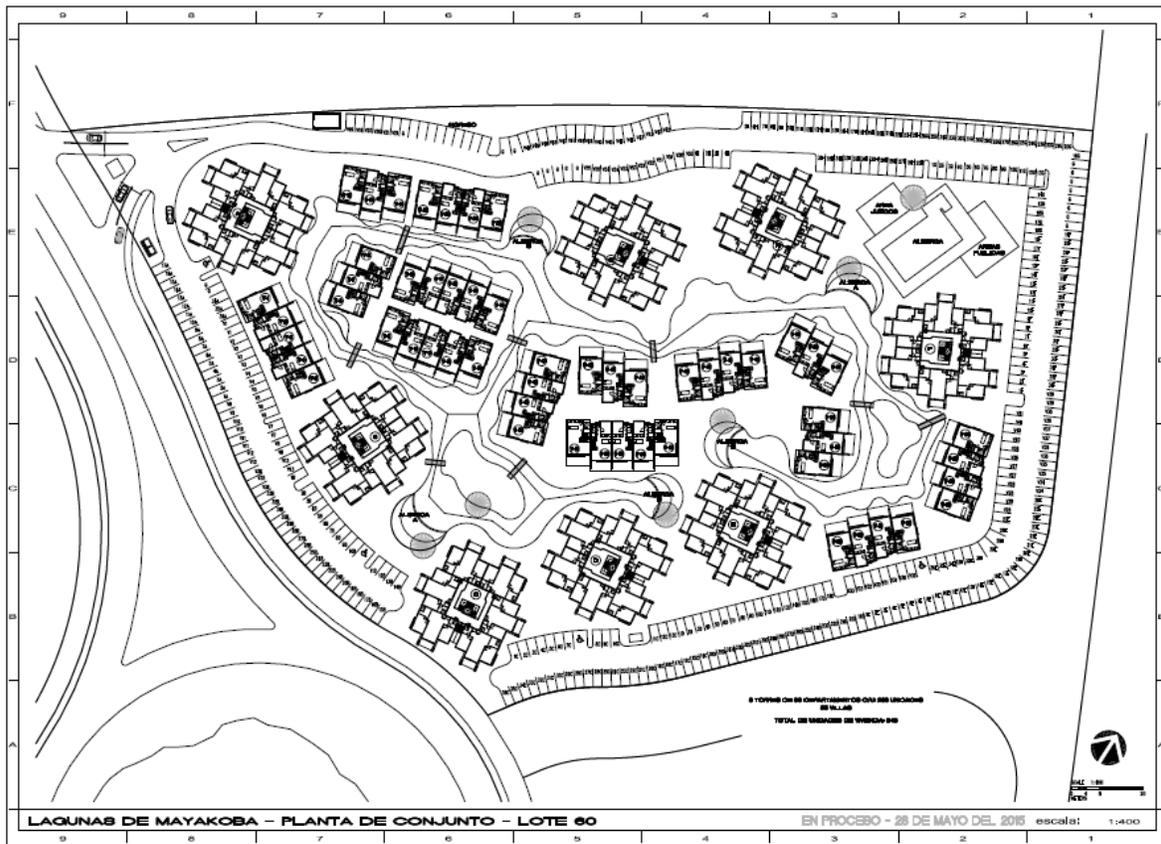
Modelo de construcción que será aplicado al lote 60 del proyecto “Lagunas de Mayakoba”. Ver anexo 2 Planos arquitectónicos.
